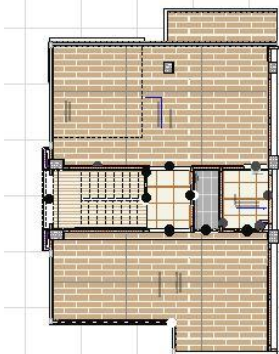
Planta 3. Tomado de Fénix Construcciones.
